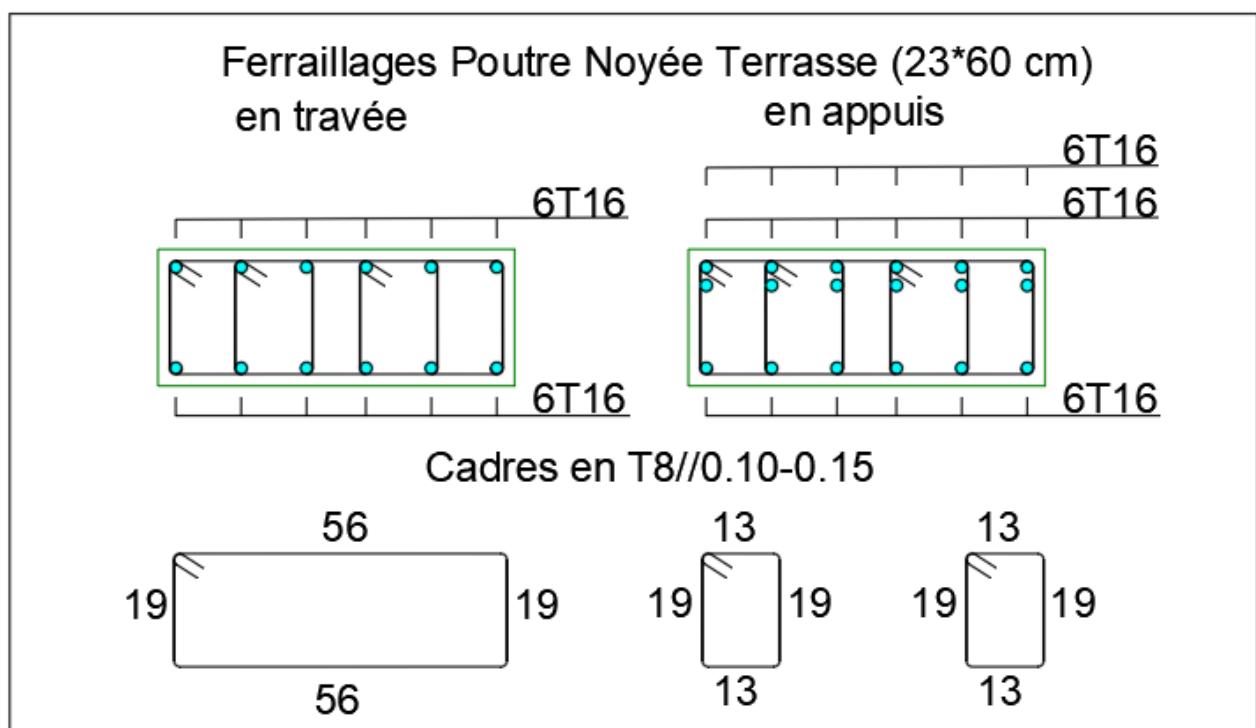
Ferraillages Poutre Noyée Terrasse 23*60 cm.
